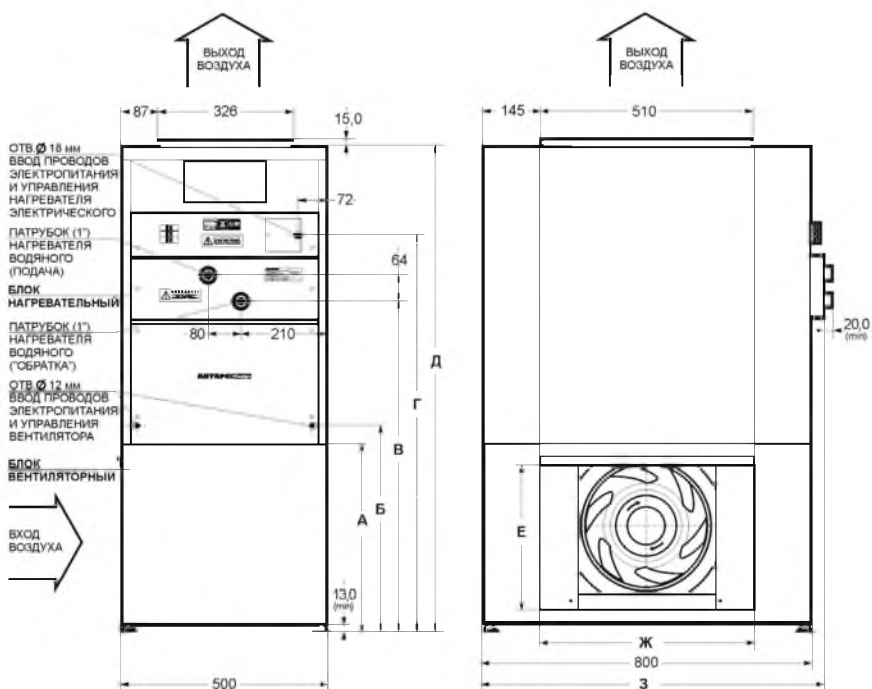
Габаритные и присоединительные размеры блоков агрегата воздушнонагревательного (АН) «АНТАРЕС Комфорт»
